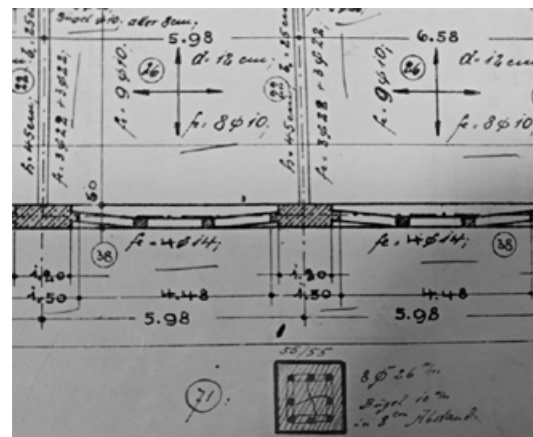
Ausschnitt Positionsplan Decke über 1. Obergeschoss (LBK, Akt-Nr. 159270).
